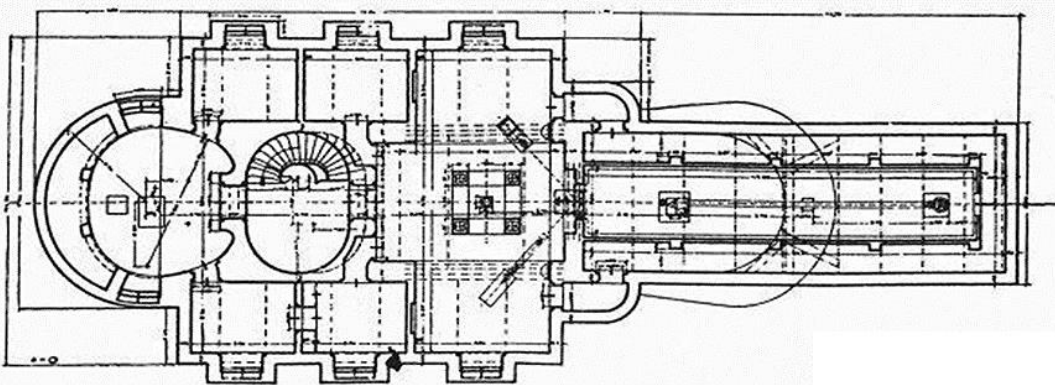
Grundriss des Kellergeschosses [26]
